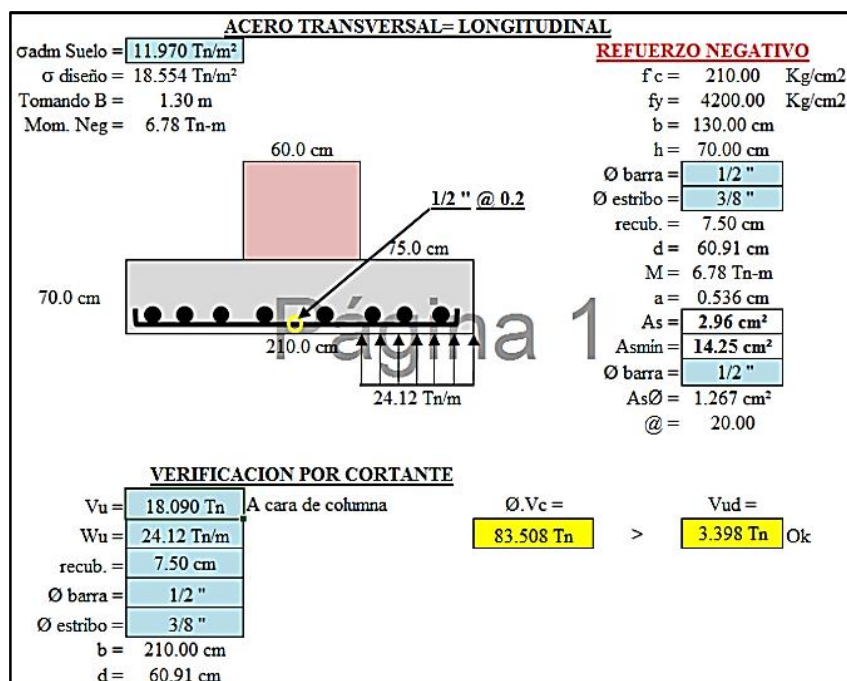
Sección y Refuerzo de Zapata Aislada Eje D-8
